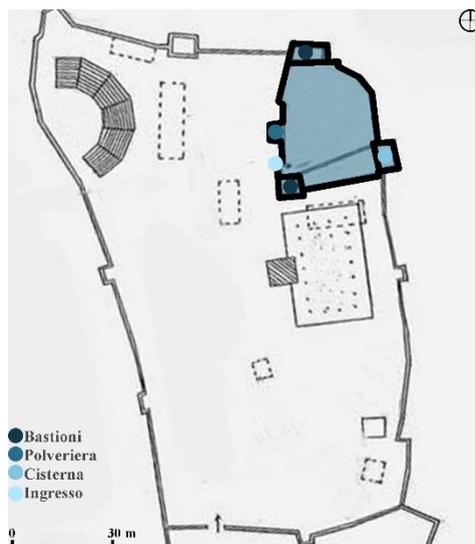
Il Castello di Trikala, planimetria generale del forte interno (Adriana Trematerra, 2023).
